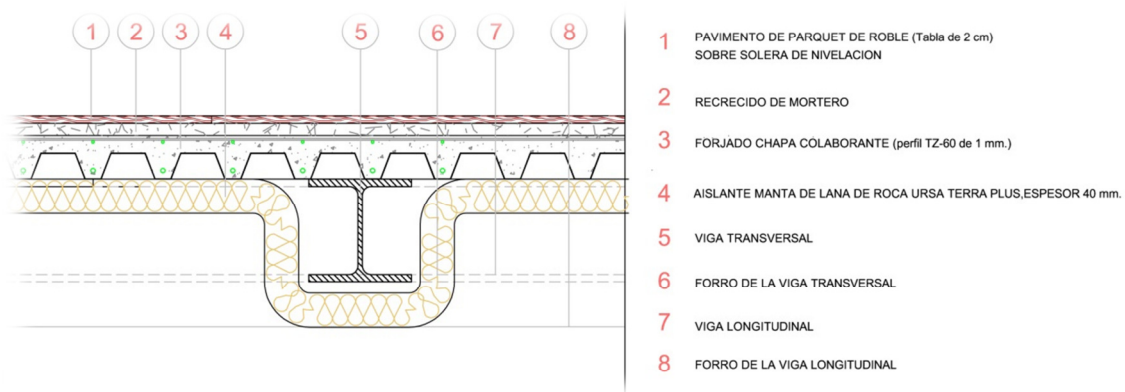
Detalle constructivo del forjado techo de entreplanta. Elaboración propia.
